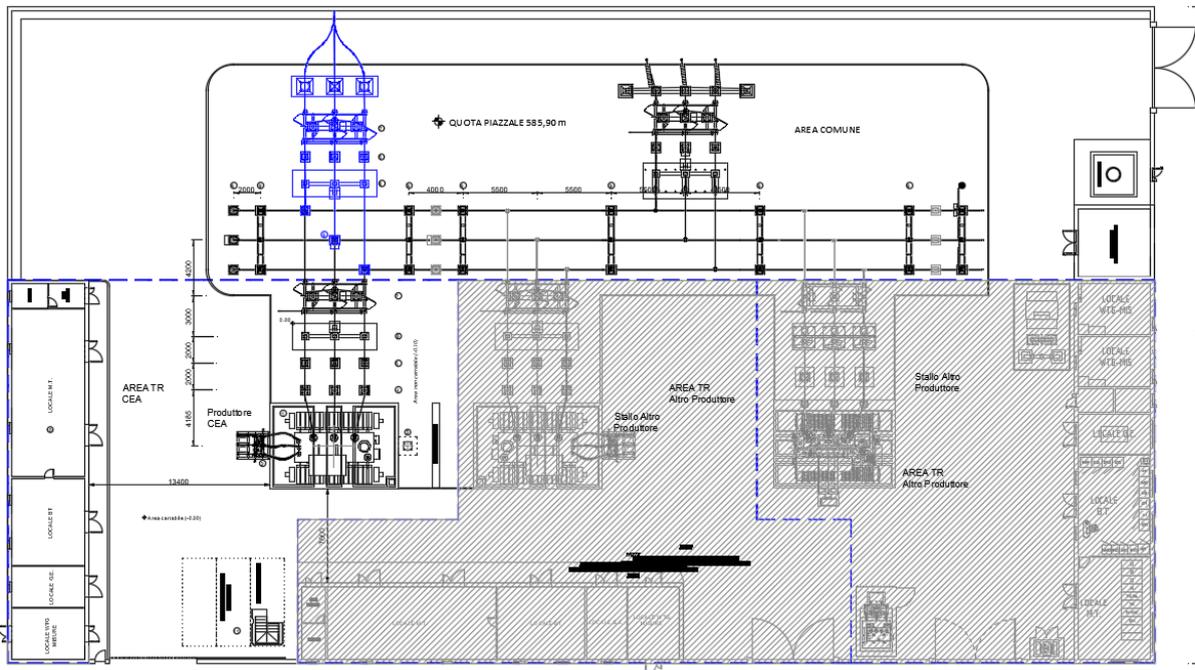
Layout stazione elettrica di utenza progetto di variante completo di stallo connessione provvisoria (blu)
